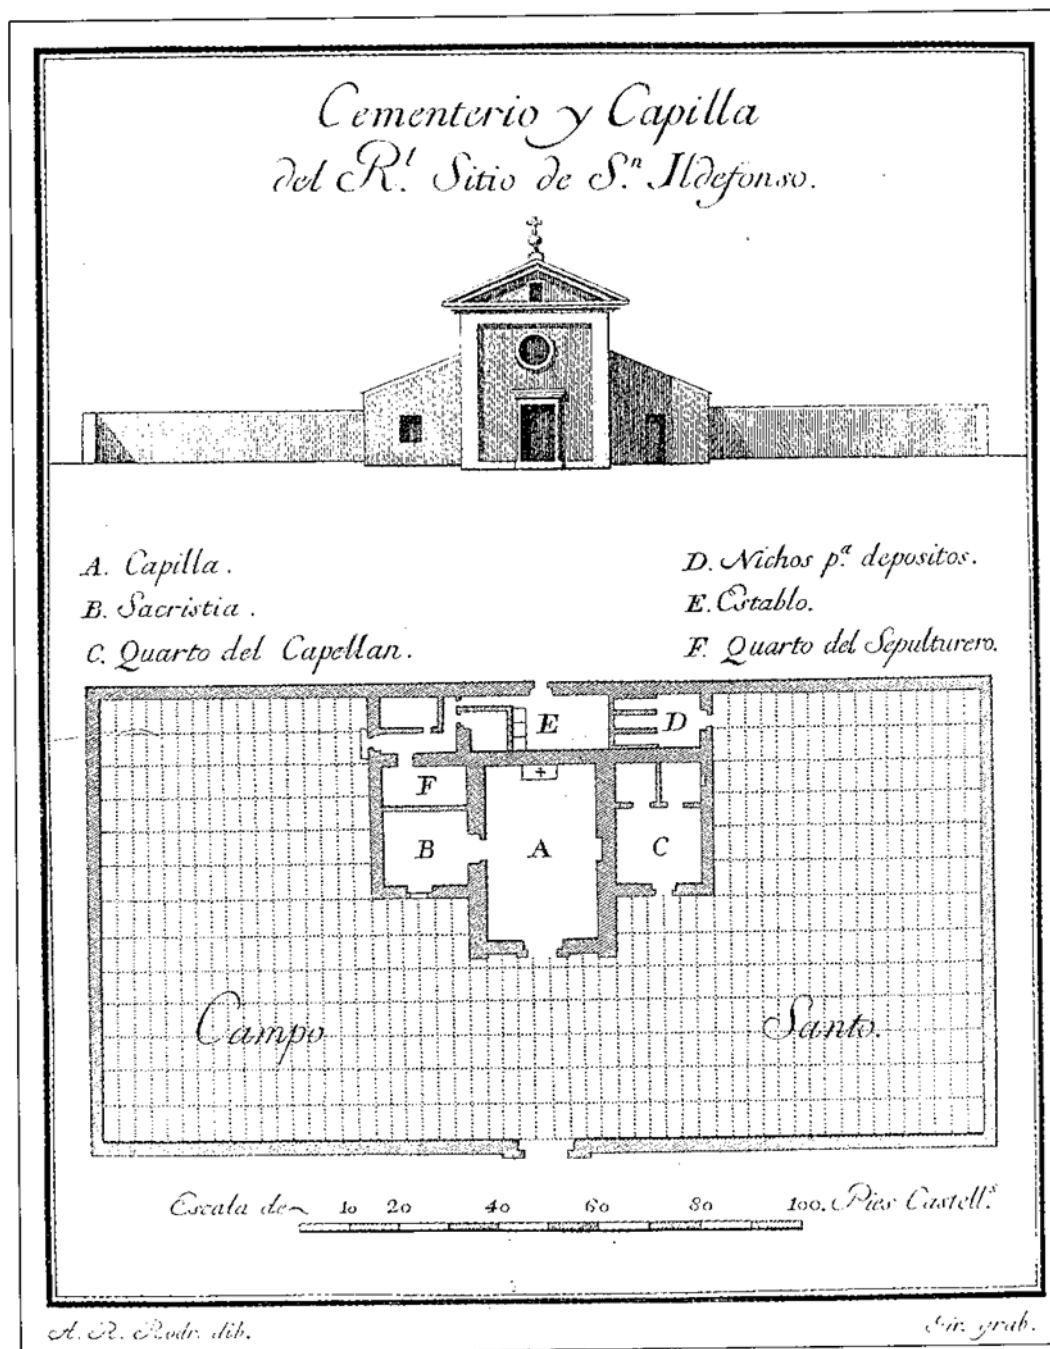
Plano que contiene la planta del cementerio construido en el Real Sitio de San Ildefonso, el perfil de su frontis y alguna información adicional²⁶⁵.
